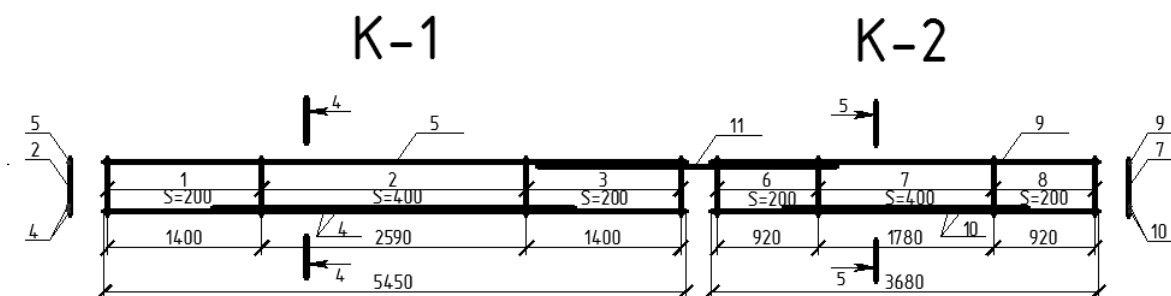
Схема армирования ригеля поперечным каркасом
